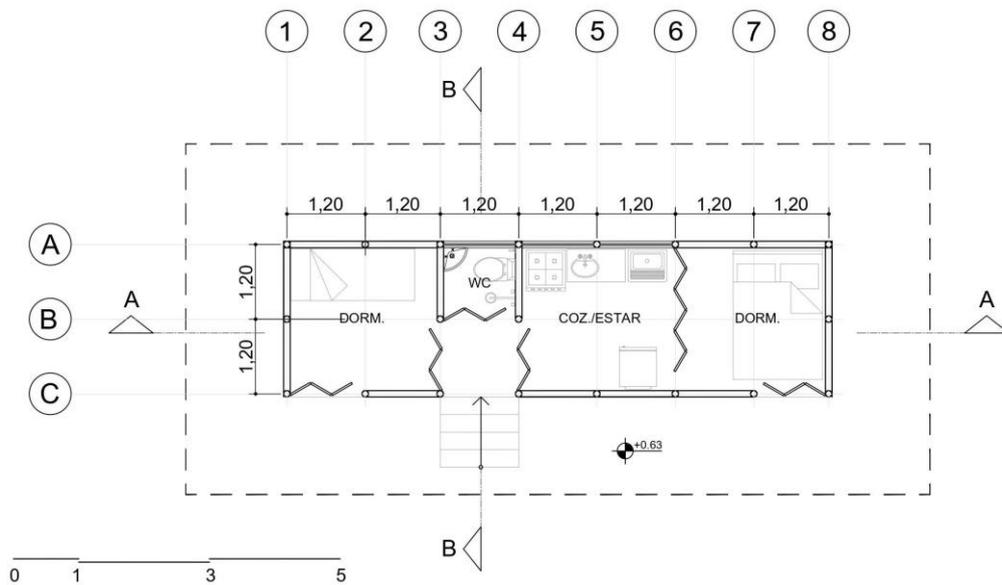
Planta baixa. Fonte: elaborado pelos autores.
